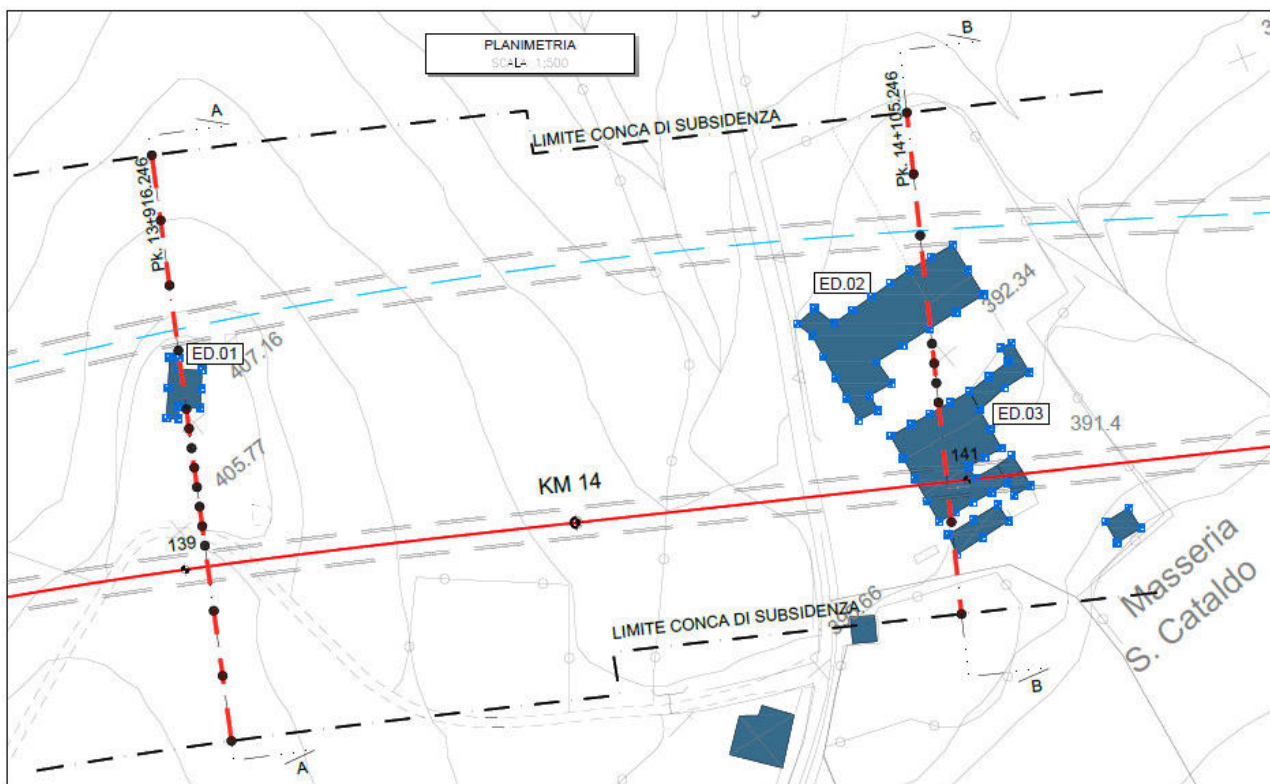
Planimetria posizione edifici zona galleria Trinacria
